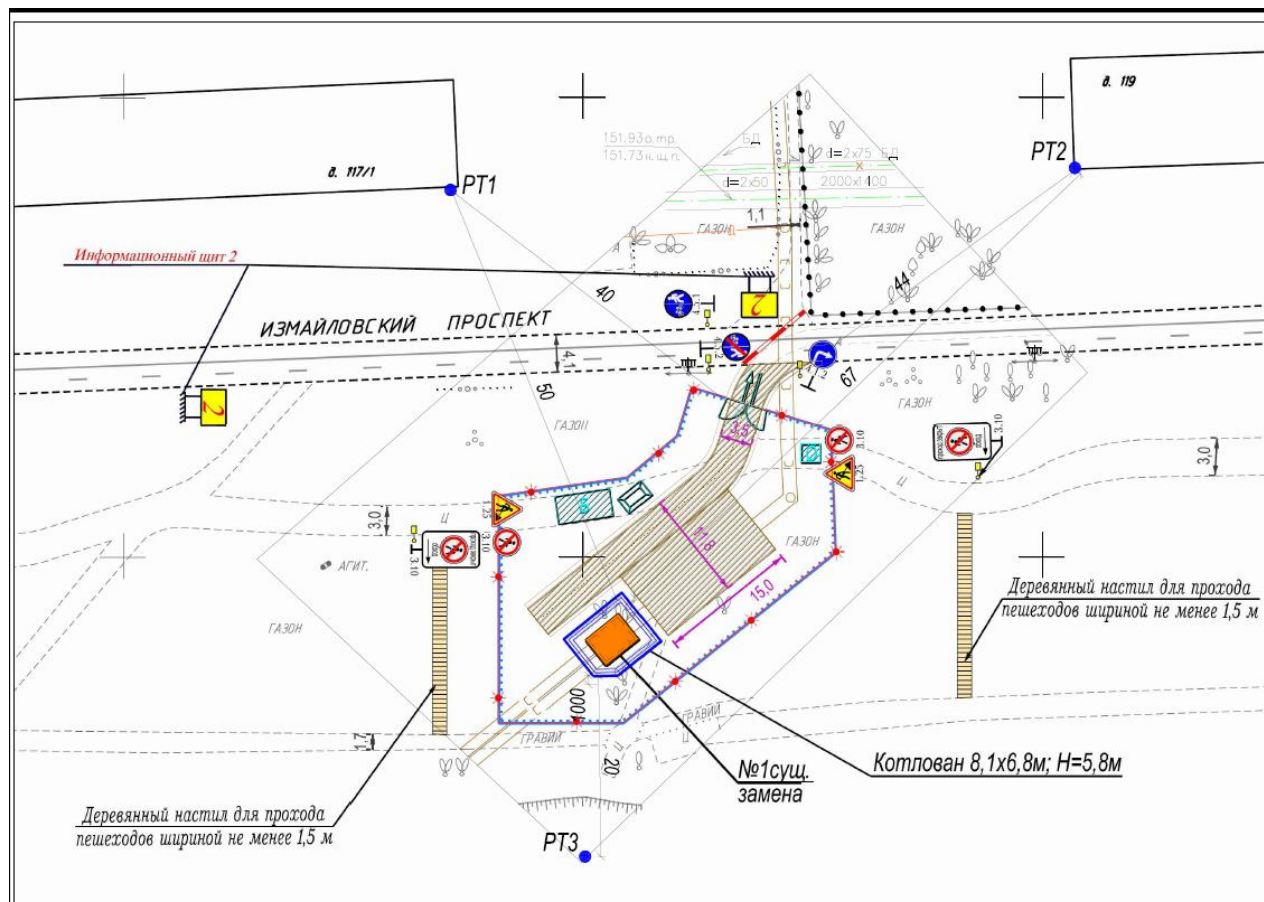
Расположение строительной площадки расчетных точек
